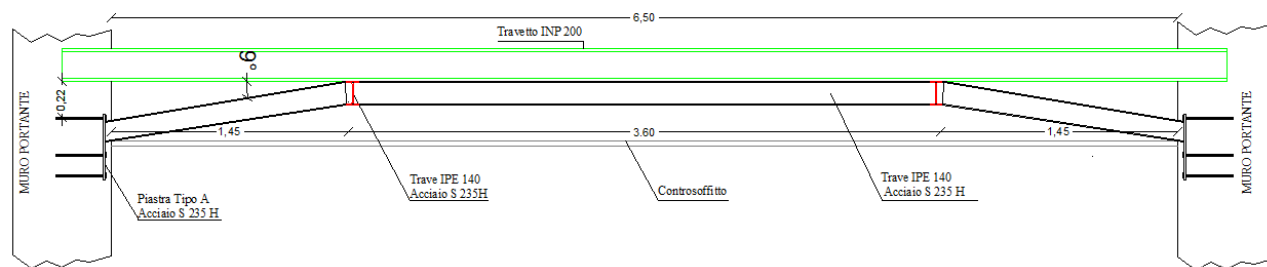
Particolare del rinforzo “A” strutturale con sottotrave in acciaio a saettoni
